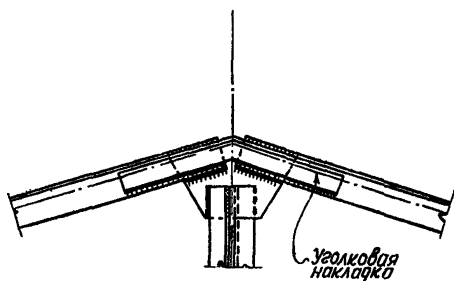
Пример конструкции коыькового узла треугольной фермы
